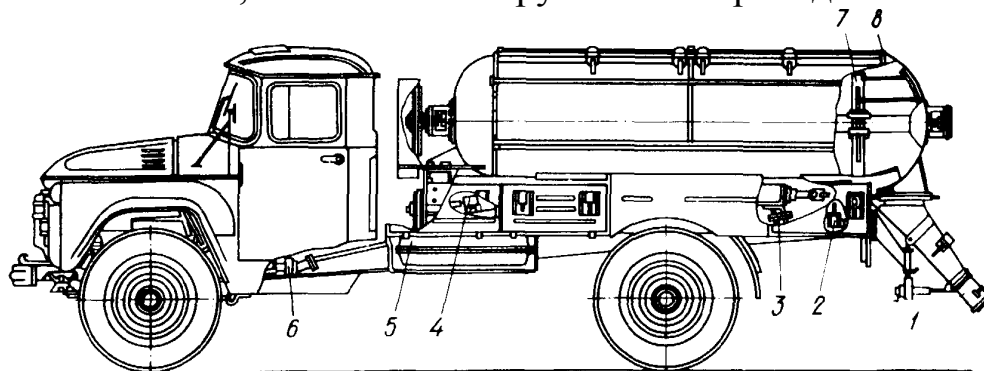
Авторастворовоз СБ-89Б: 1 – разгрузочное устройство; 2 – рукоятка управления; 3 – затвор; 4 – блокирующий гидрораспылитель; 5 – привод побудителя; 6 – коробка отбора мощности; 7 – побудитель; 8 – цистерна
